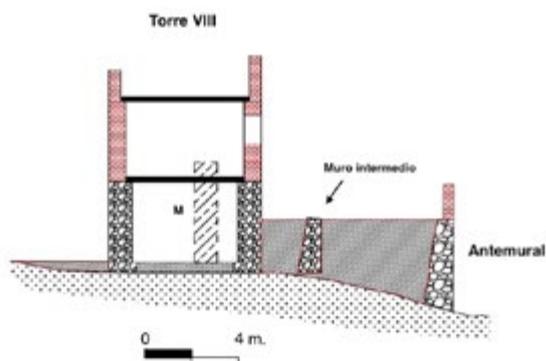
Sección reconstruida de la fortificación a la altura de la torre VIII. M es la posición de la muralla contra los muros laterales de la torre. Ilustración M. Olcina.
